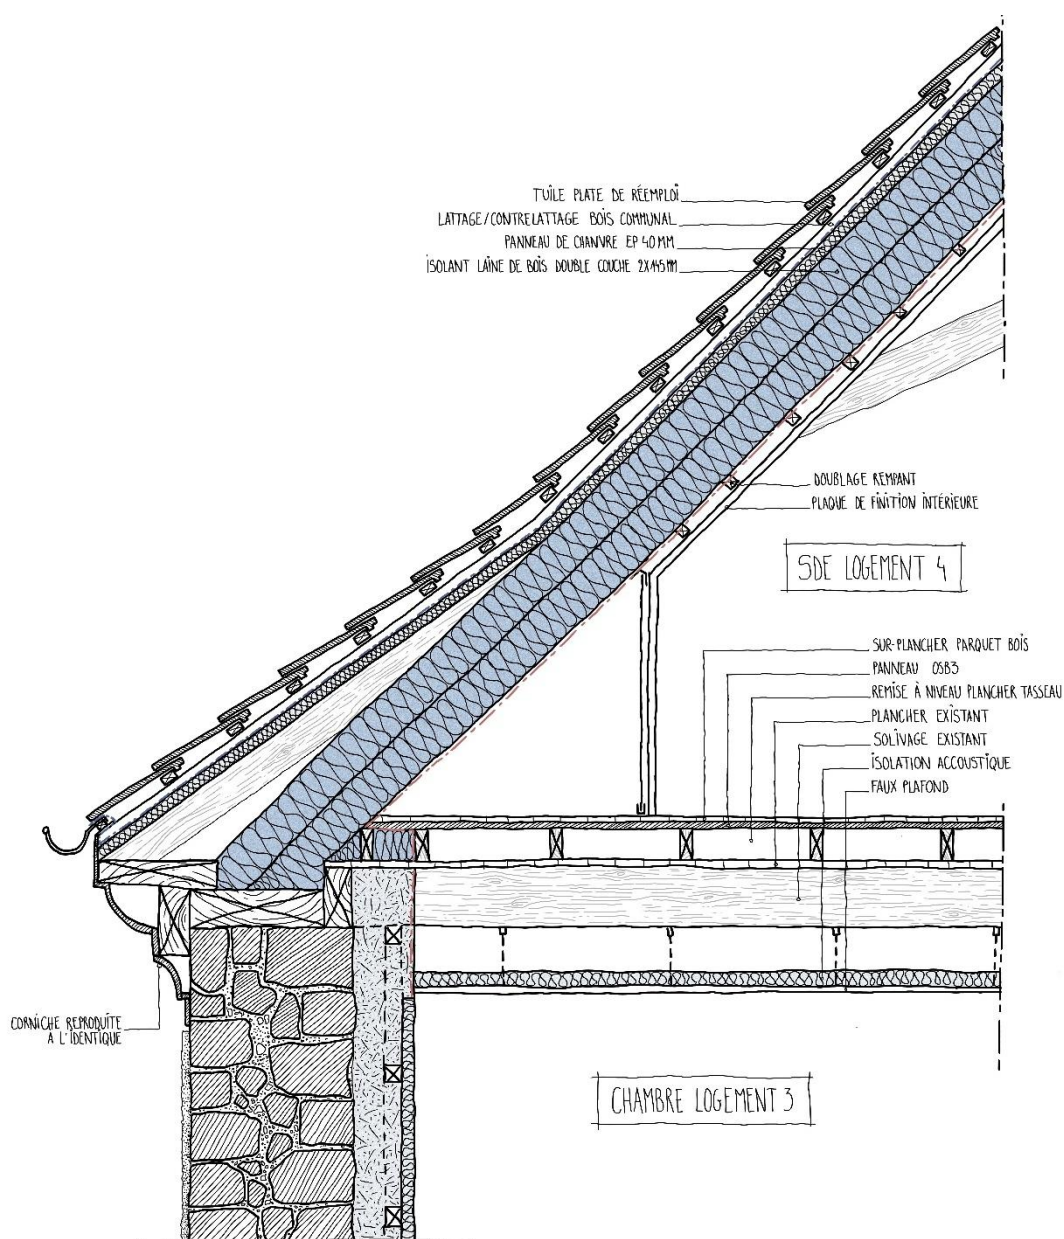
Croquis de la toiture (source Mayker Architectes)
